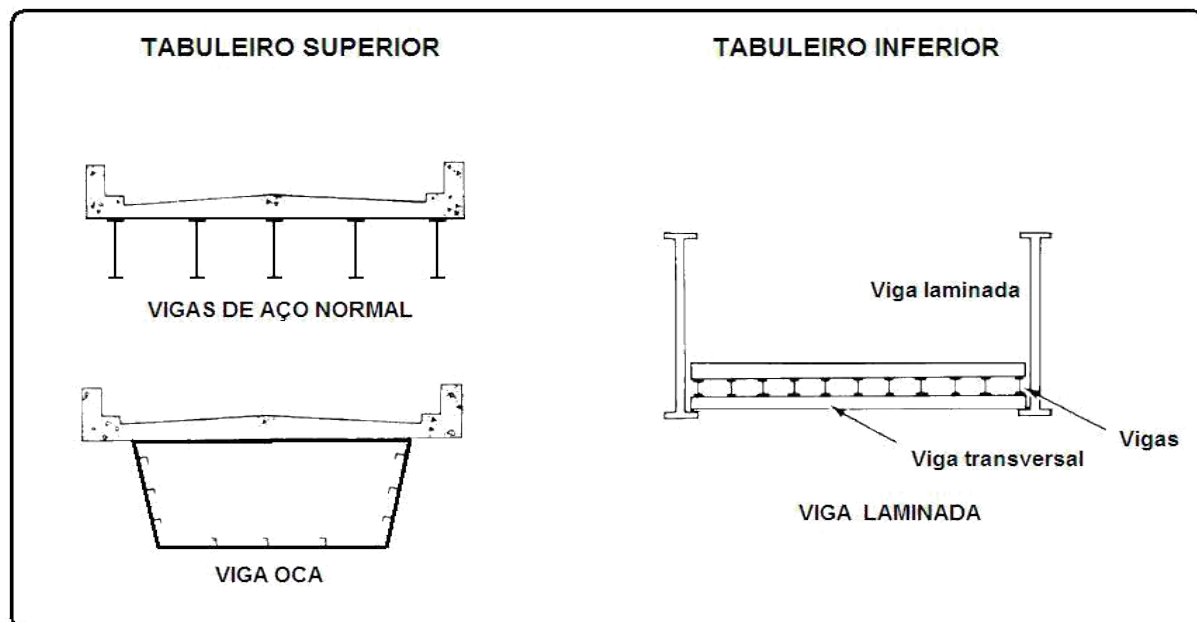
Típicas seções de ponte de vigas de aço (lance simples)
